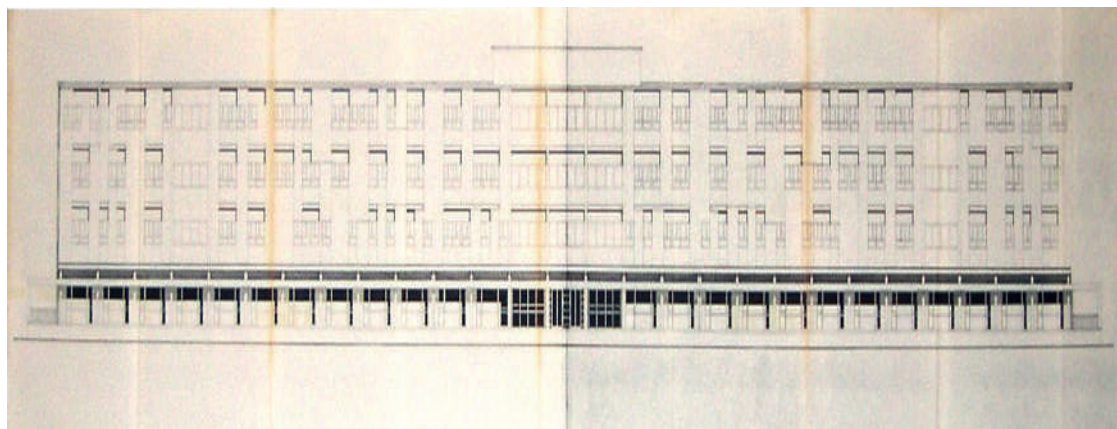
Raffaele Argo, Progetto di completamento e ristrutturazione dell'Ospedale, 2° lotto. Monoblocchi A e B. Prospetto ovest, scala 1:100, 20 marzo 1972 [da AOAPPCNa].
